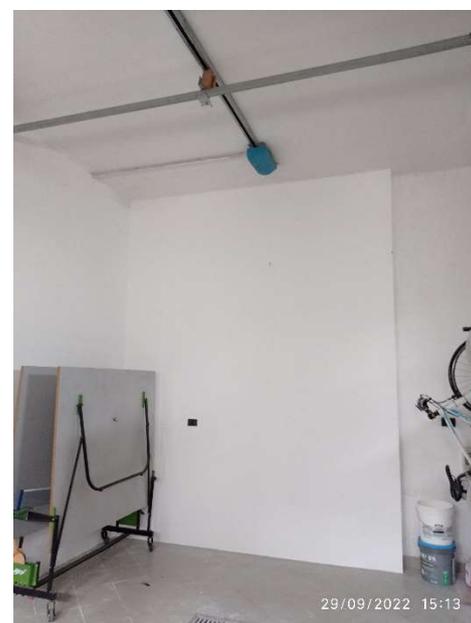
Realizzazione isolamento parete verso locale non riscaldato garage
